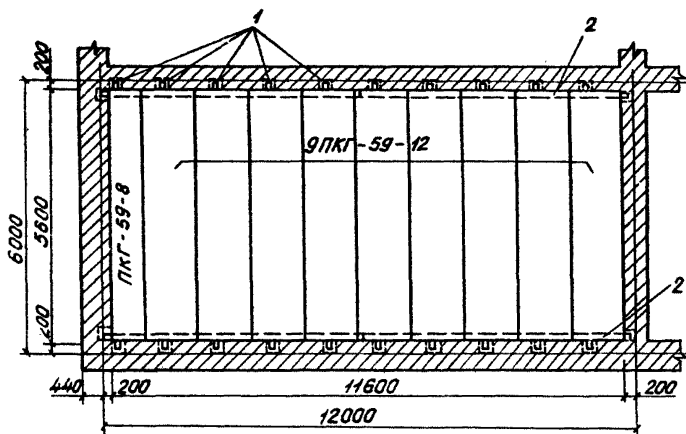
План участка перекрытия из железобетонных плит ПКГ с опиранием на опорные гребенки МГО-1.
